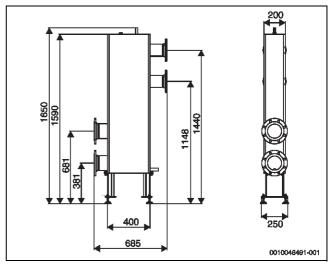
Weichengruppe für 2-Kessel-Kaskade 2 × 350 kW, 2 × 400 kW, 2 × 500 kW (Maße in mm)
